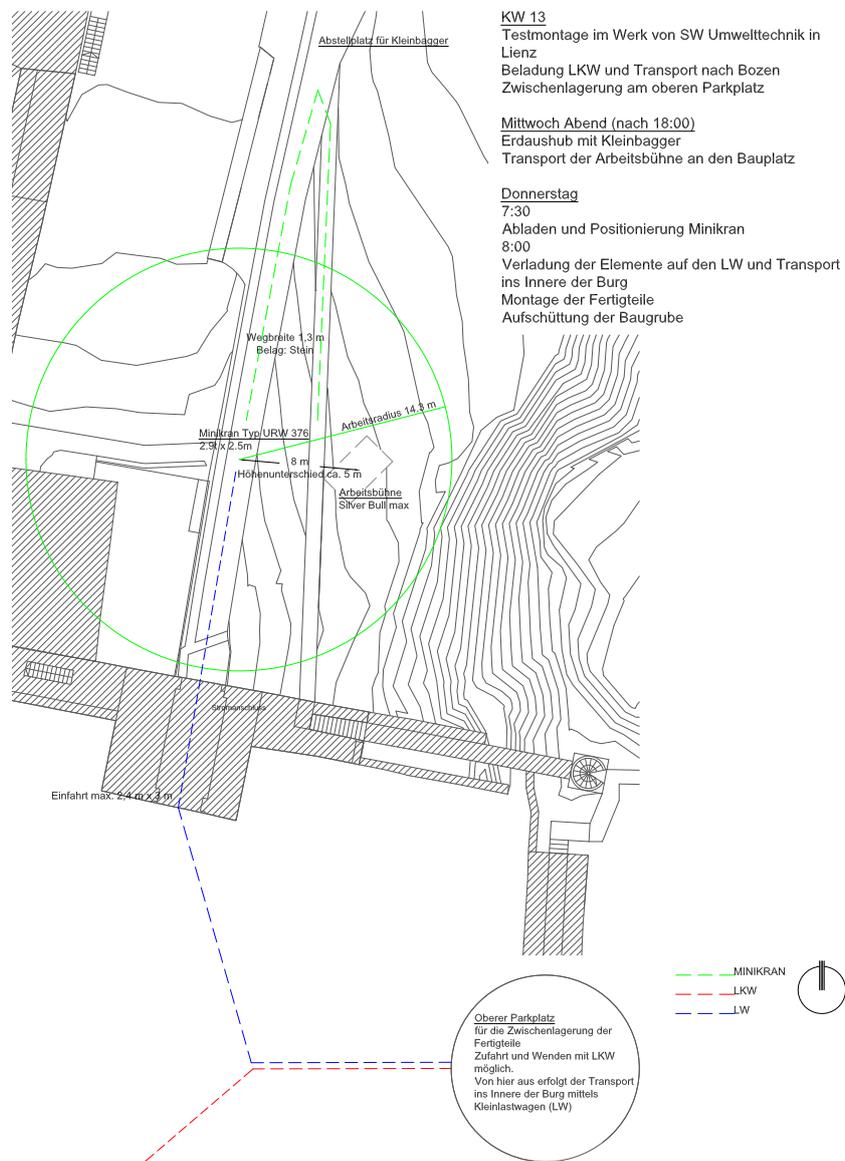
Der geplante Ablauf der Montagearbeiten und die Positionierung der Maschinen
